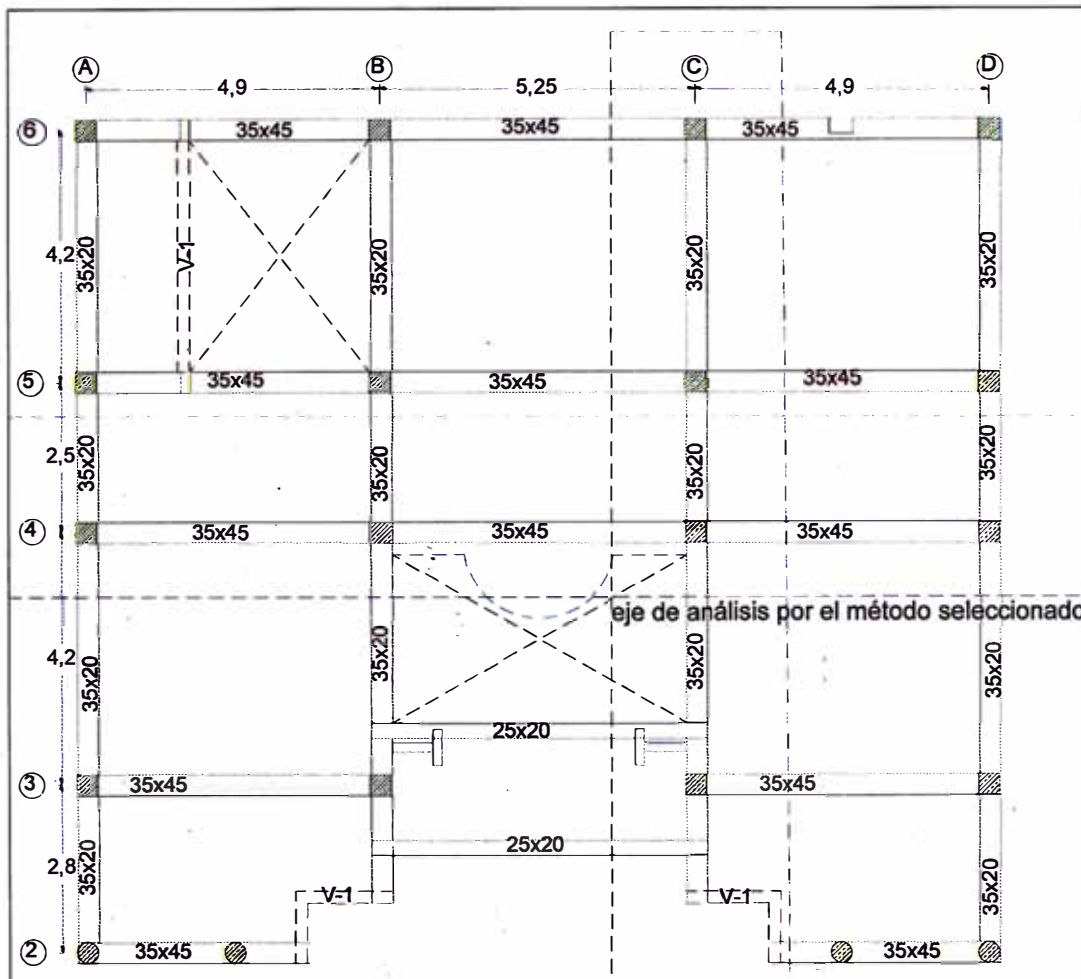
Planta segundo piso del edificio municipal – elementos estructurales
